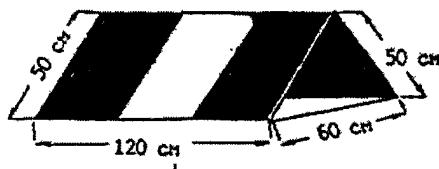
Размеры пирамиды для обозначения границ вертолетной площадки
